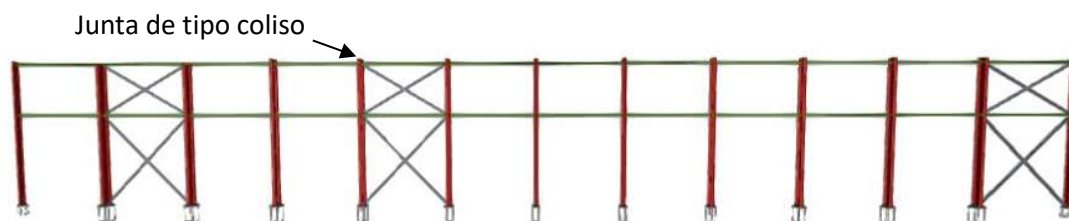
Distribución de las correas de la cubierta y los laterales.
